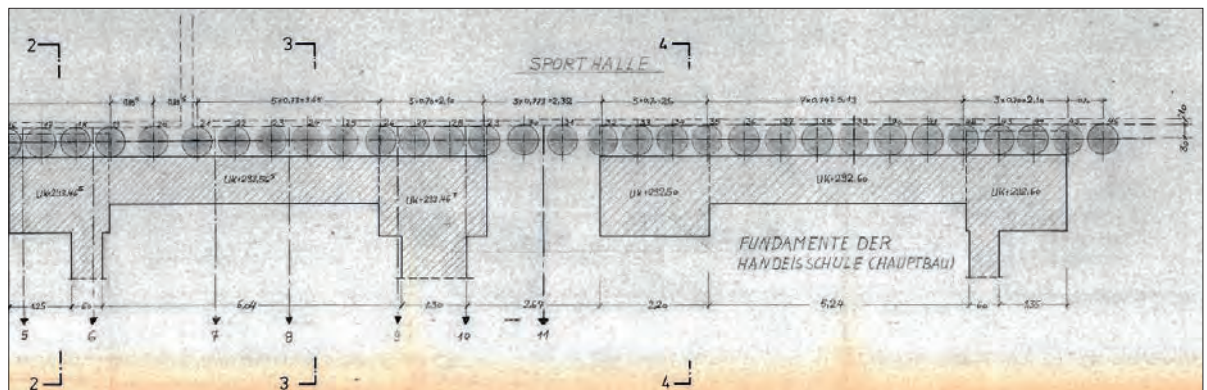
Lageplan und Schnitte mit Angaben zur Verankerung und zum Verbau/Bilfinger + Berger Bau AG (Auszug) [15c]
